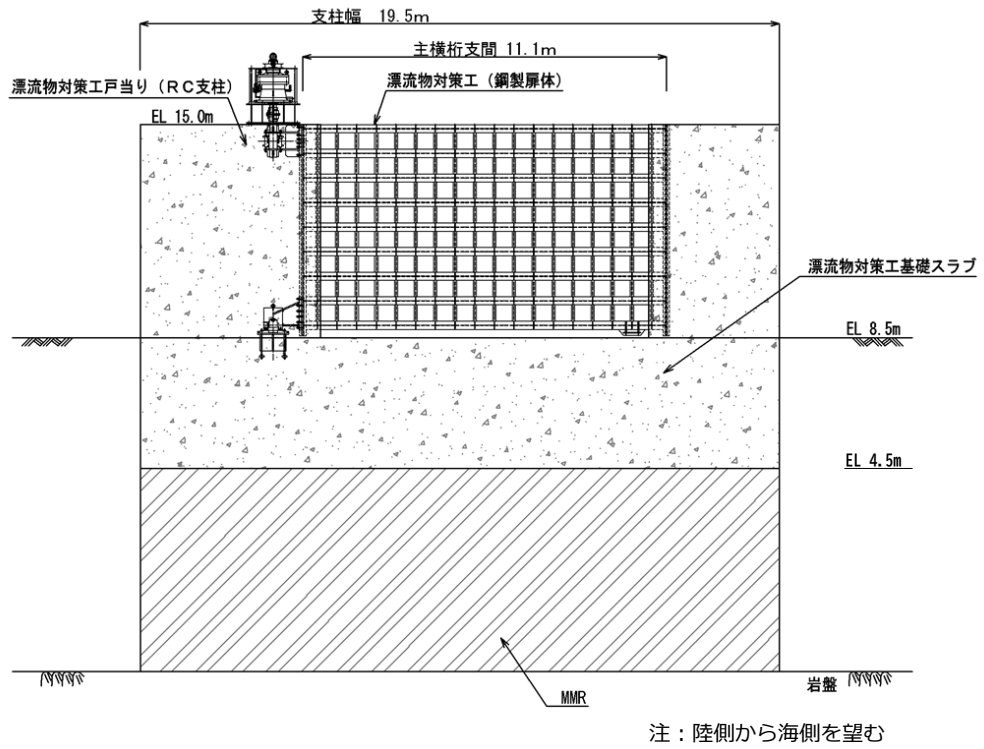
(1) 漂流物対策工の構造図 (基礎正面図, A-A 断面)
